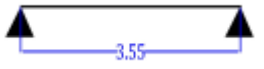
Disposition des poutrelles du 2^{ème} étage
